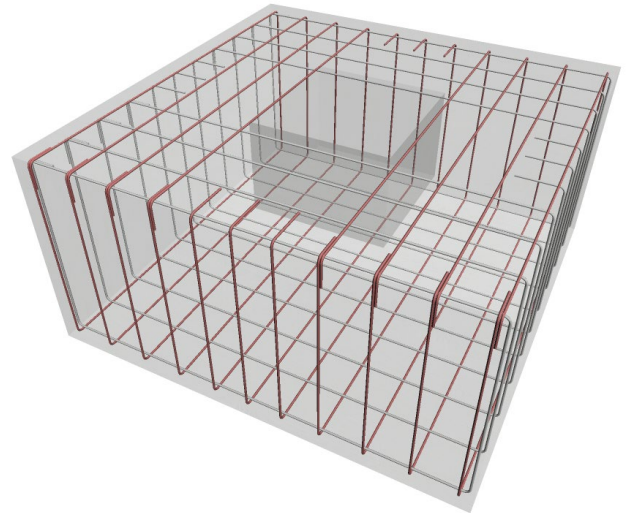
Kombination aus geschlossenem und offenem Bügel mit Haken – untere Bewehrung
